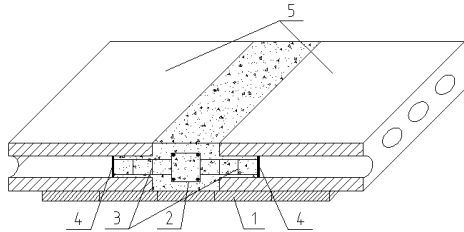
Способ устройства сборно – монолитного перекрытия: 1 – опалубка; 2 – арматурный каркас ригеля; 3 – дополнительные плоские арматурные каркасы; 4 – ограничители; 5 – сборные многоспустотные плиты перекрытия
